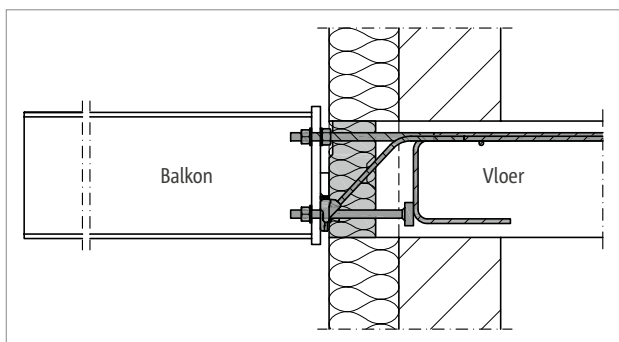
Schöck Isokorb® T type SK: in de spouwmuurisolatie; verbindingstuk op de werf aangebracht tussen het Isokorb® element en het balkon. Biedt flexibiliteit tijdens het bouwproces (achteraf montage)
